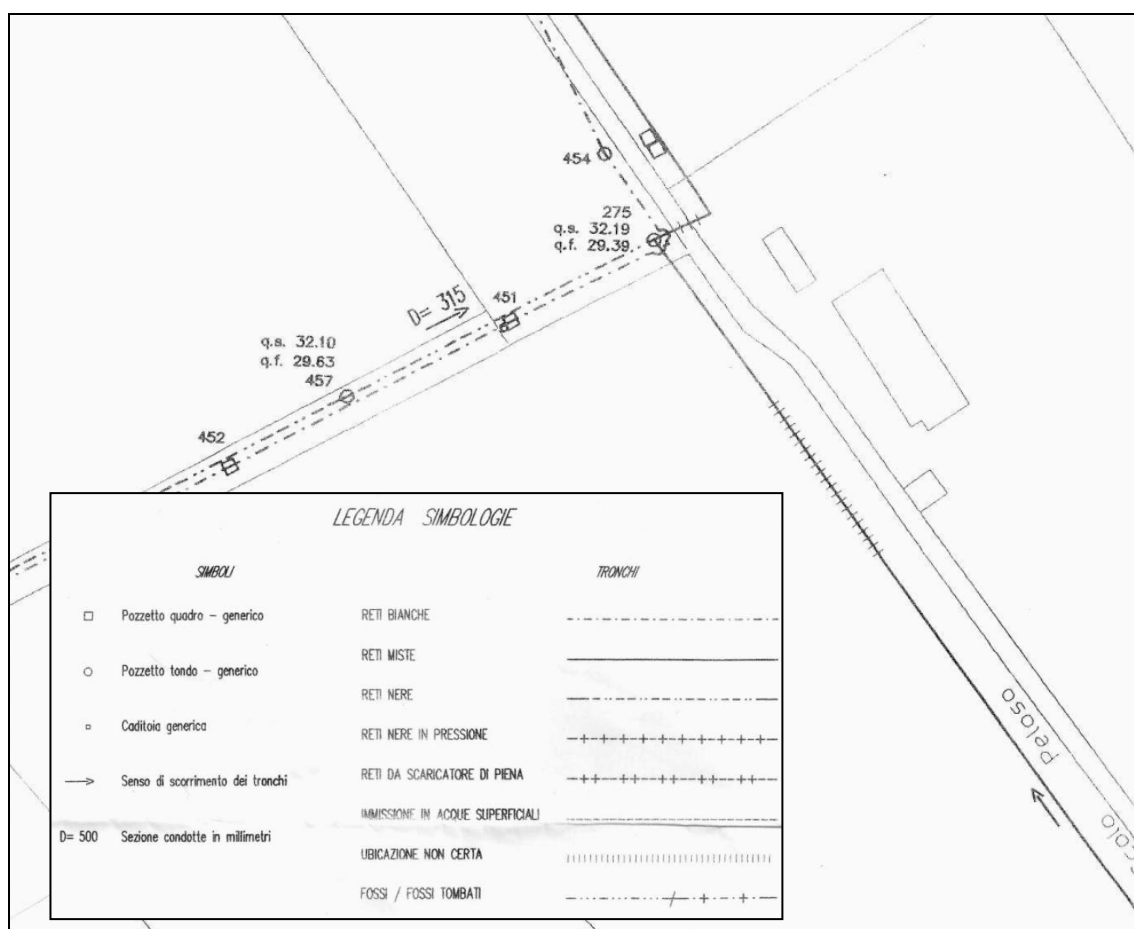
Schema della rete fognaria in prossimità dell'ingresso dello stabilimento attuale.
